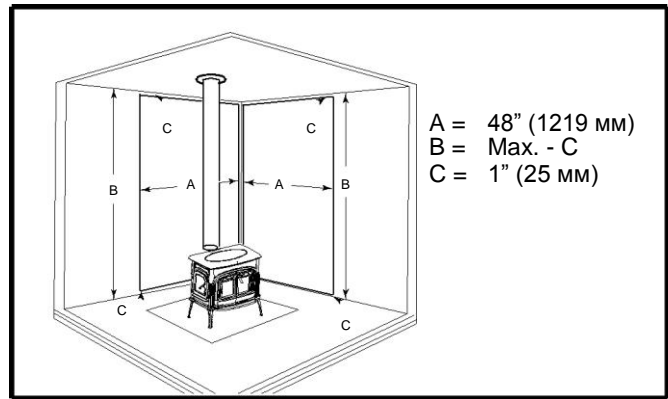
Одобренная конструкция тепловой изоляции стены
